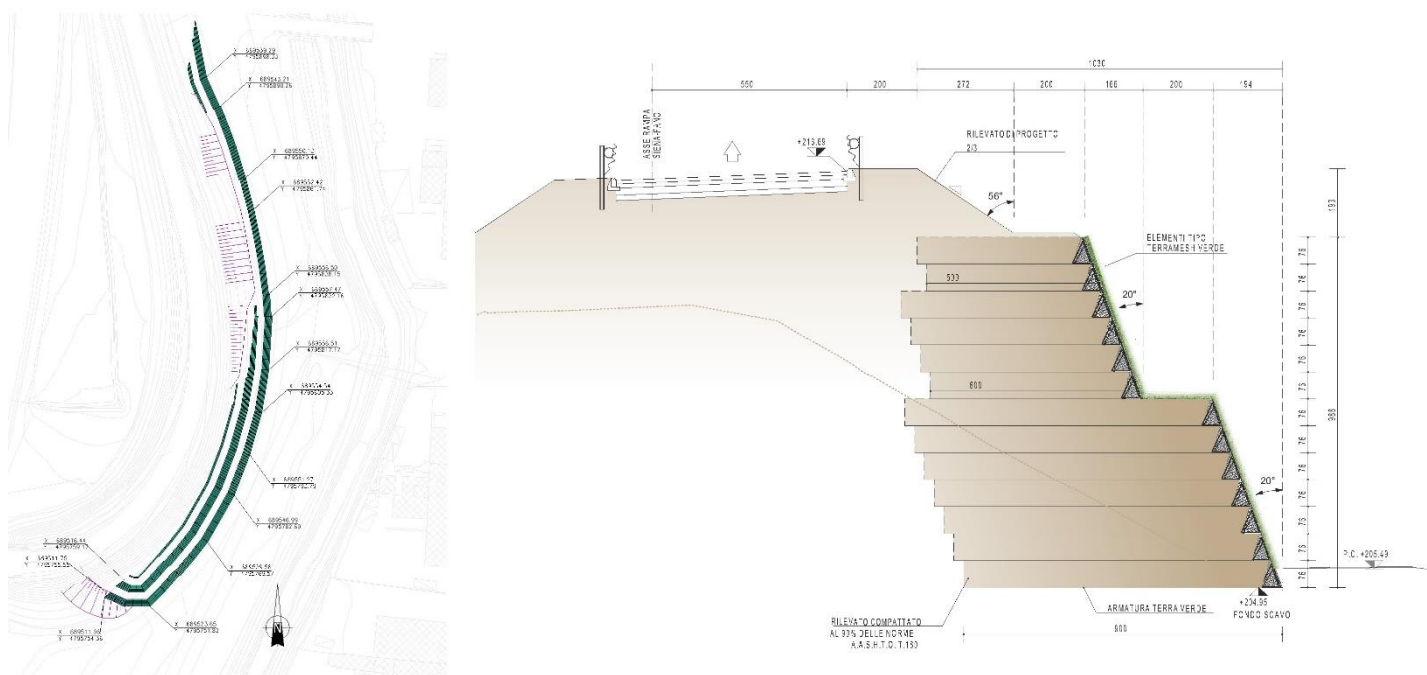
Pianta e sezione dell'intervento in terra mesh
